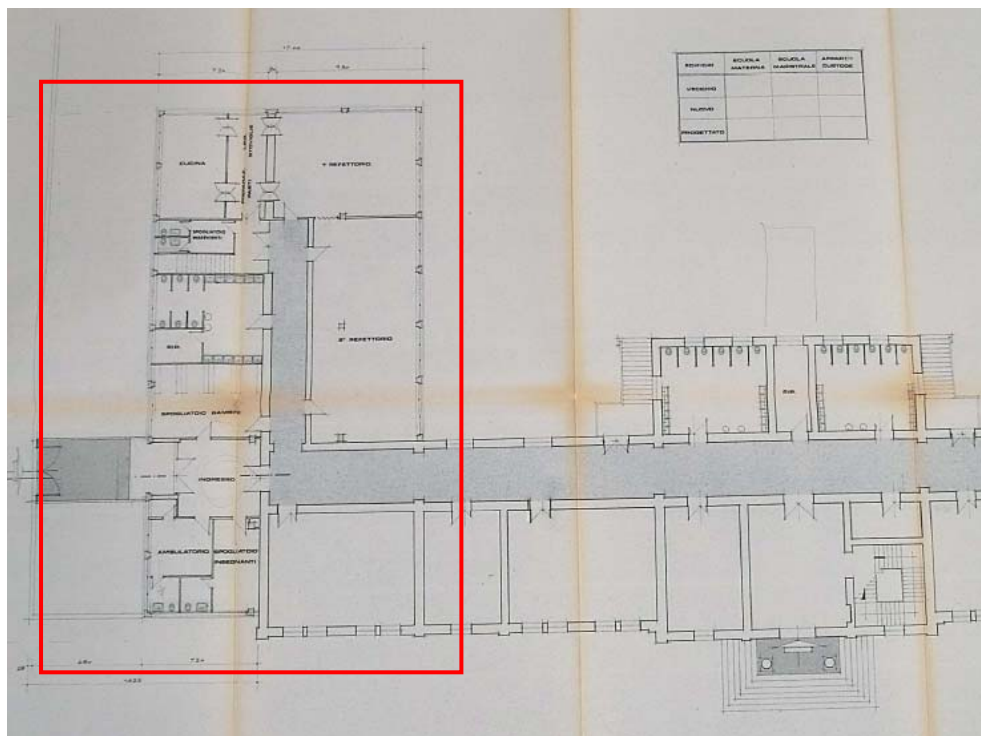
Piano rialzato – ampliamento/sopraelevazione Blocco B
